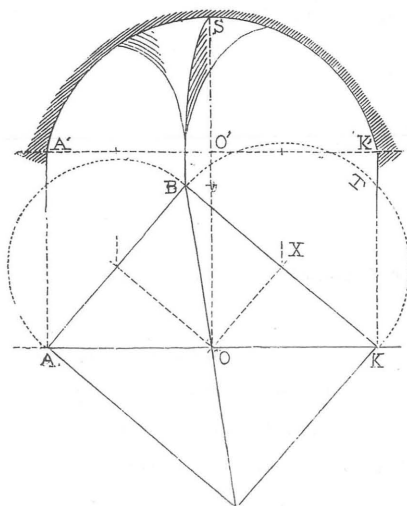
Bóveda de arista peraltada, planta y sección diagonal
